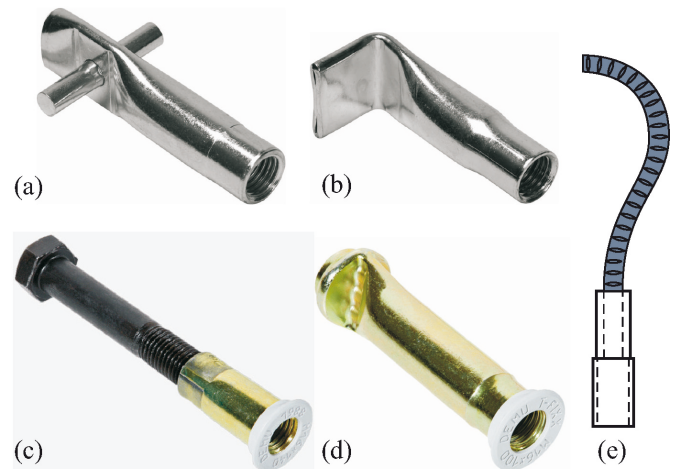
Typische Hülsenanker (a) bis (d) und gebogener Rippenstab mit aufgedrückter Hülse (Wellenanker) (e)
